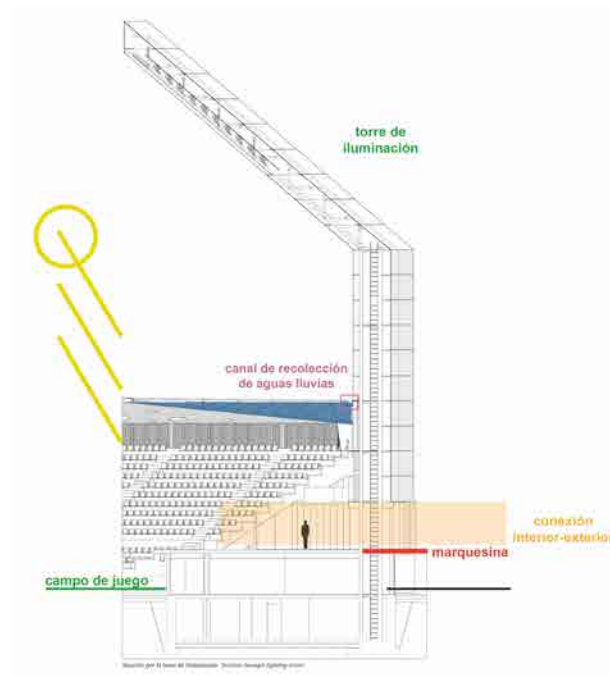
Sección constructiva. Fuente: <https://arquitecturaviva.com/>
